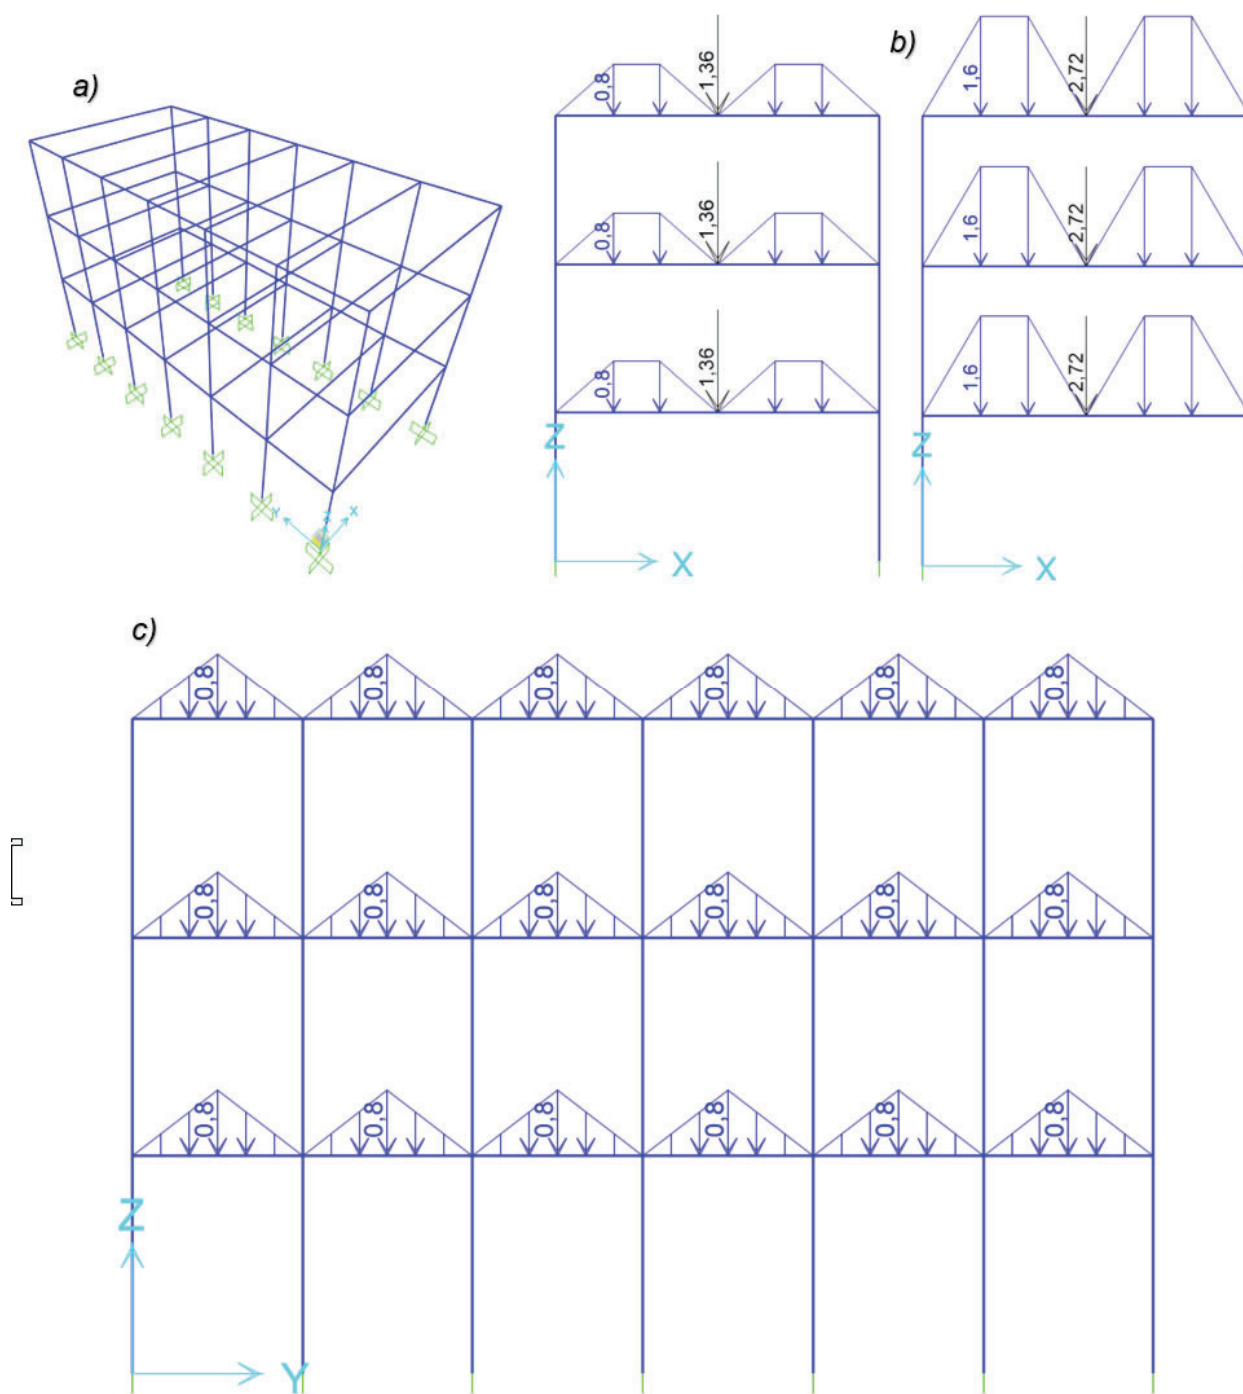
a) Modelo 3D de la vivienda unifamiliar b) Vista frontal XZ de pórticos internos y externos junto con la distribución de carga muerta en toneladas sobre las vigas principales. c) Vista lateral YZ de pórticos externos junto con la distribución de carga muerta en toneladas sobre las vigas principales.
